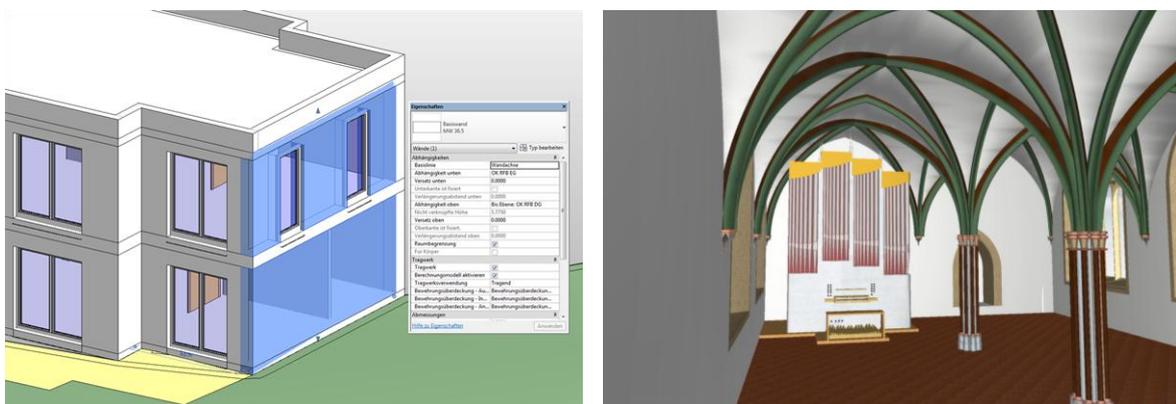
Links: BIM-Modell der Stadtvilla im Bauhausstil mit selektierter Wand im normierten Rohbaumaß (inkl. Putzabzug), visualisiert in der BIM-Autorensoftware Revit von Autodesk. Rechts: BIM-Modell des gotischen Klosterbaus mit Deckenkonstruktion bestehend aus Bündelpfeiler, Rippen und Kappe, visualisiert in der BIM-Autorensoftware Allplan von Nemetschek.
